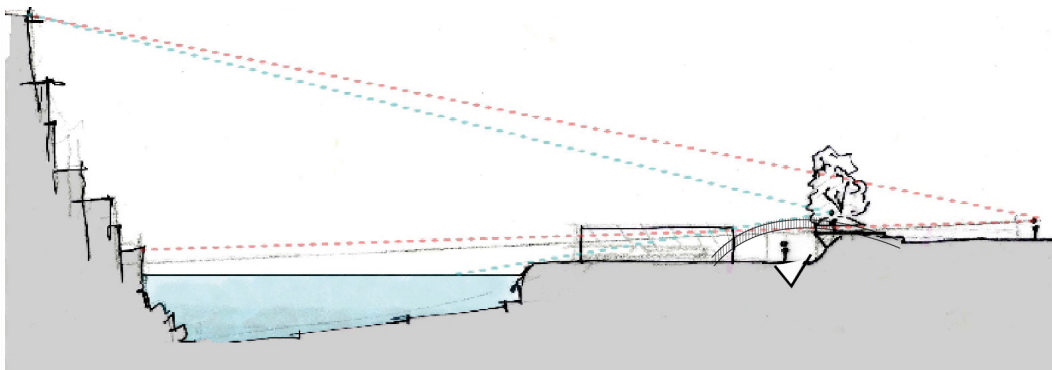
Une des principales difficultés du site est la sécurisation de l'accès au plan d'eau. Pour rendre le plan d'eau inaccessible en période nocturne, la ville a mis en place une grille qui n'est pas satisfaisante d'un point de vue paysager. D'autres systèmes pourraient être étudiés. Ainsi un système dit de «saut de loup» (figure 3) pourrait permettre de limiter l'accès sans nuire à la qualité du paysage. Dans ce cas, l'accès au plan d'eau via une passerelle offrirait une solution satisfaisante à un coup modique. Mais un système en escalier pourrait tout aussi bien convenir. Les solutions proposées devront en tout cas tenir compte de la qualité paysagère du site.
